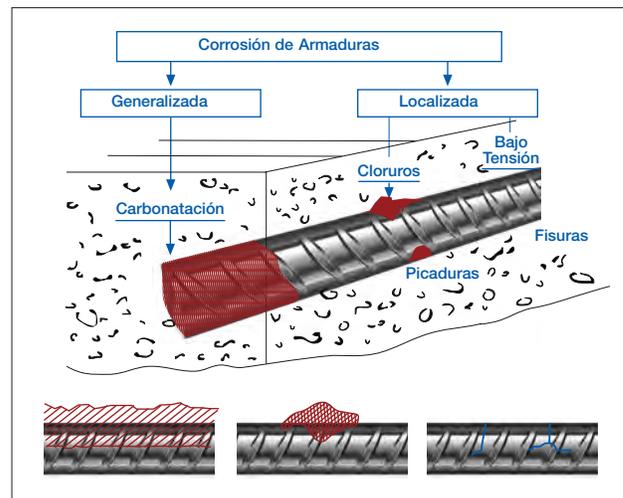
Tipología de la Corrosión en la Armadura
